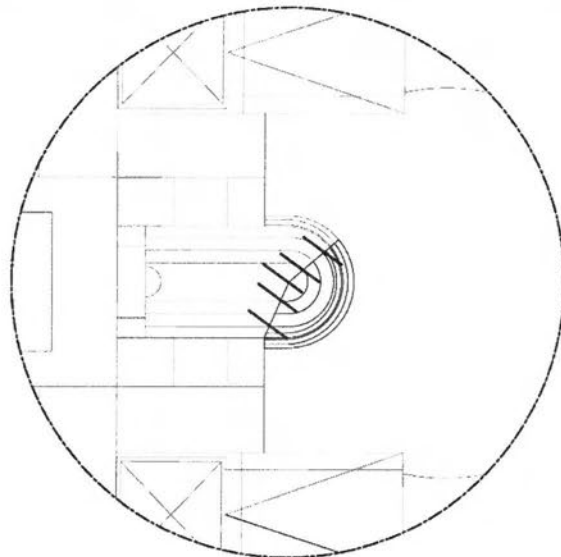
Plano de detalle reintegración fuente fachada oriente. Fuente: Municipalidad de Providencia
